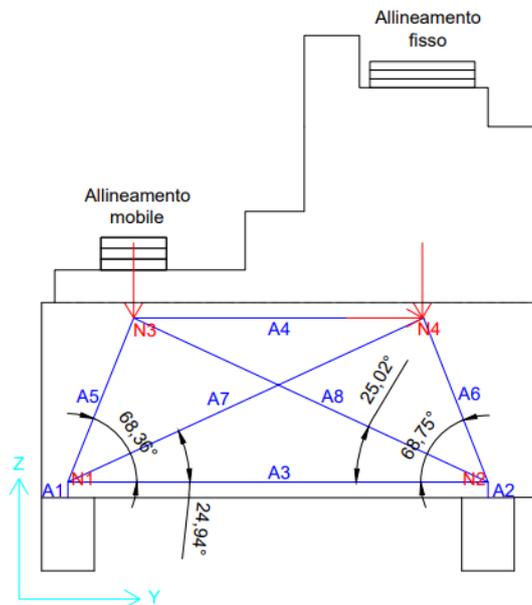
Modello a traliccio di puntone e tiranti (direzione longitudinale)
